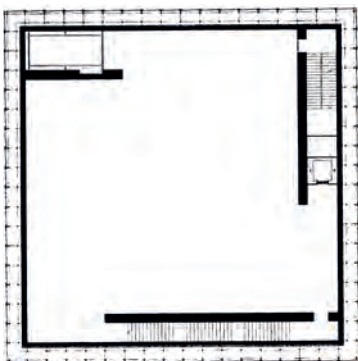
Grundriss des Kunsthauses Bregenz
